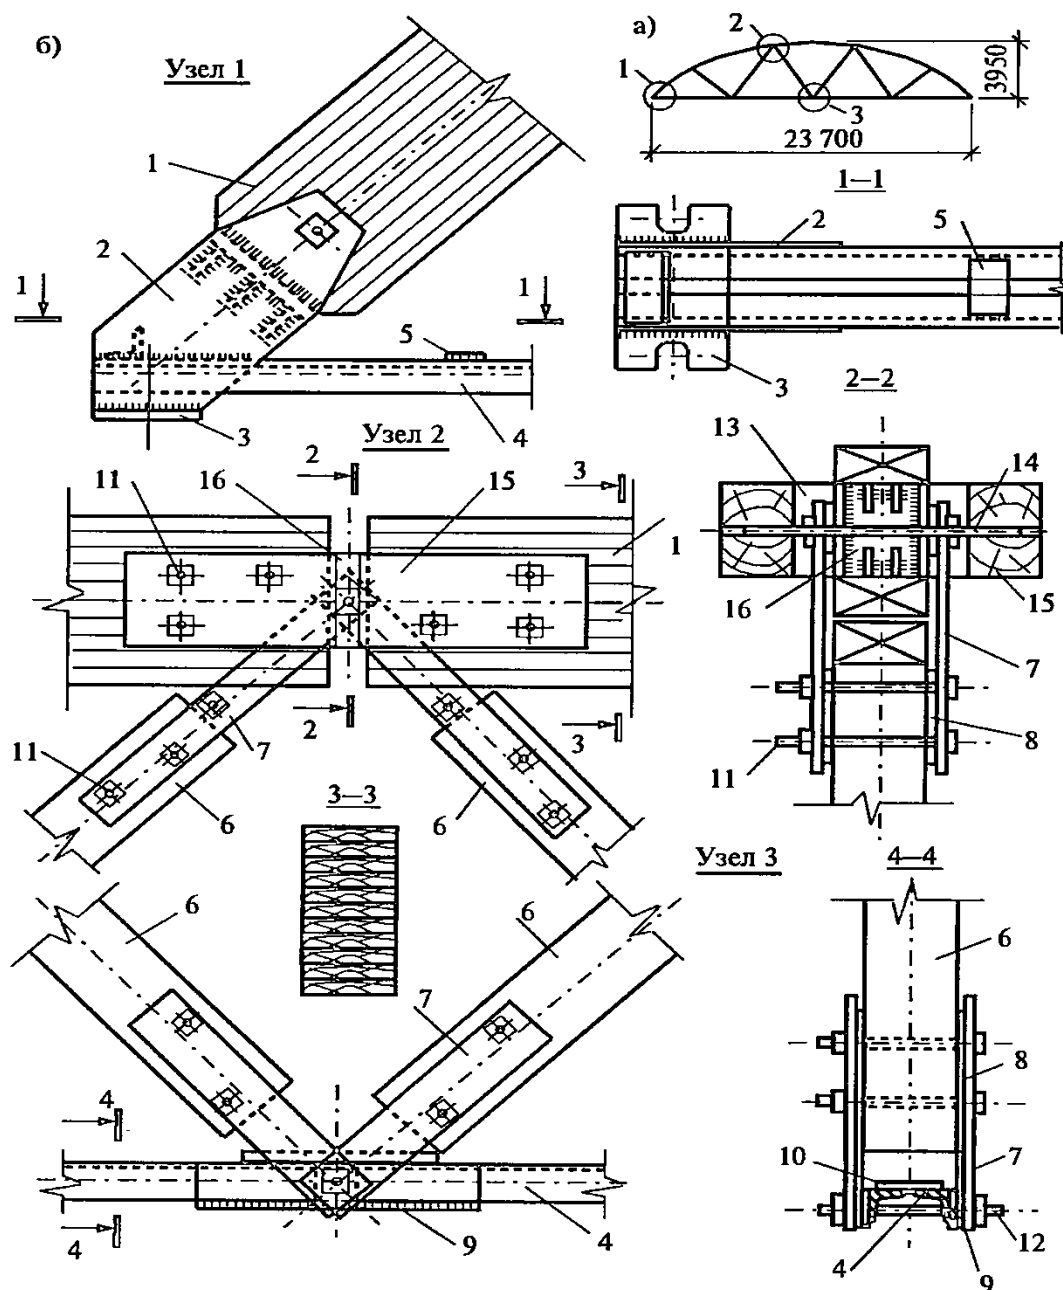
Сегментная металлодеревянная ферма: а) геометрическая схема; б) узлы фермы: 1 — верхний пояс; 2 — щеки башмака; 3 — опорная плита; 4 — нижний пояс; 5 — планки; 6 — раскосы; 7 — планки; 8 — подкладки; 9 — стыковые накладки; 10 — накладки; 11 — болты; 12 — узловой башмак с ребрами; 13 — вырез в накладках; 14 — болт; 15 — накладки; 16 — сварной башмак с ребрами
